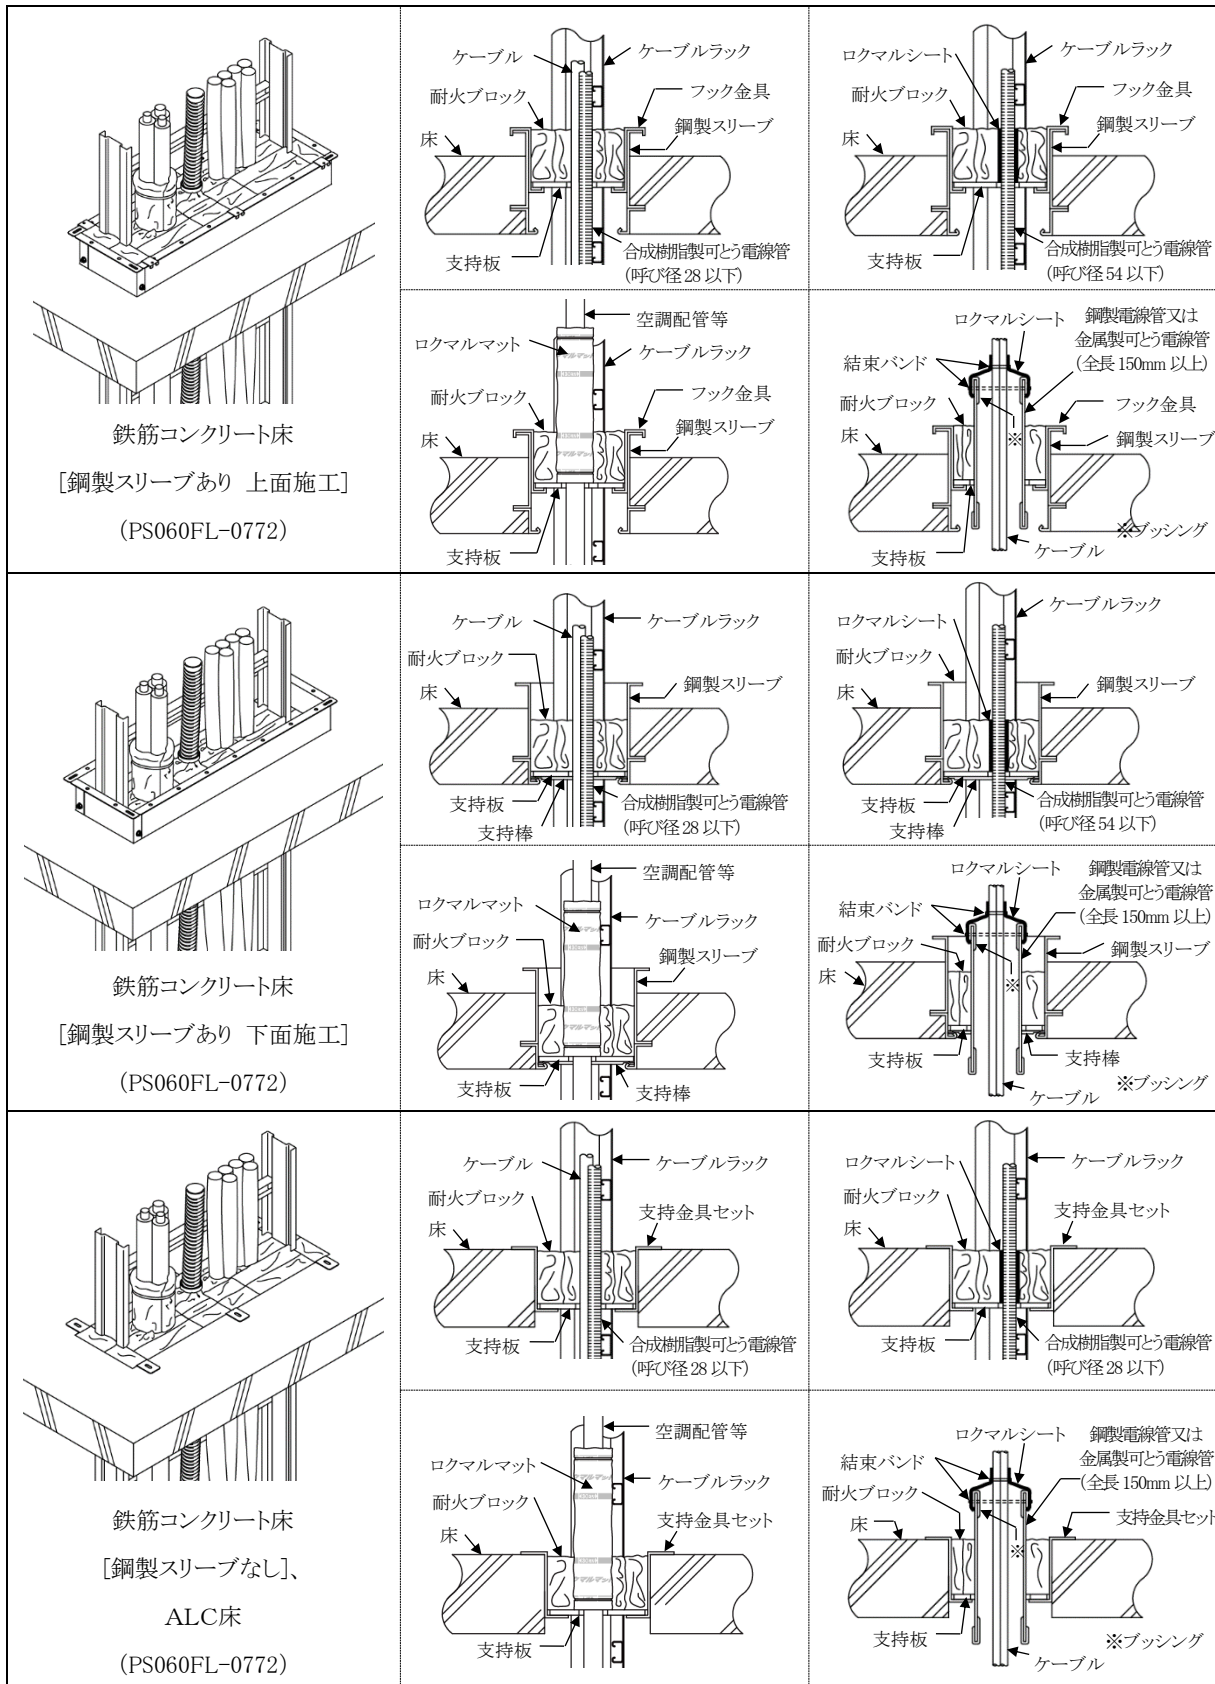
標準施工図(鉄筋コンクリート・ALC床の場合)
